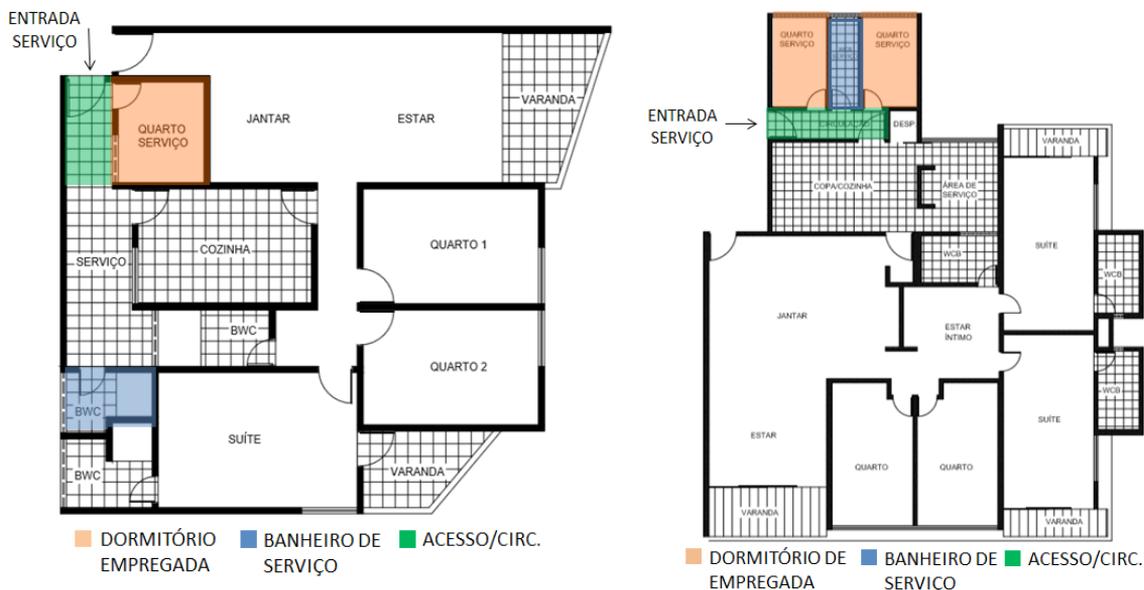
e 18: Planta baixa de unidade de Edifício de 1984 e Planta baixa de unidade de Edifício de 1988
